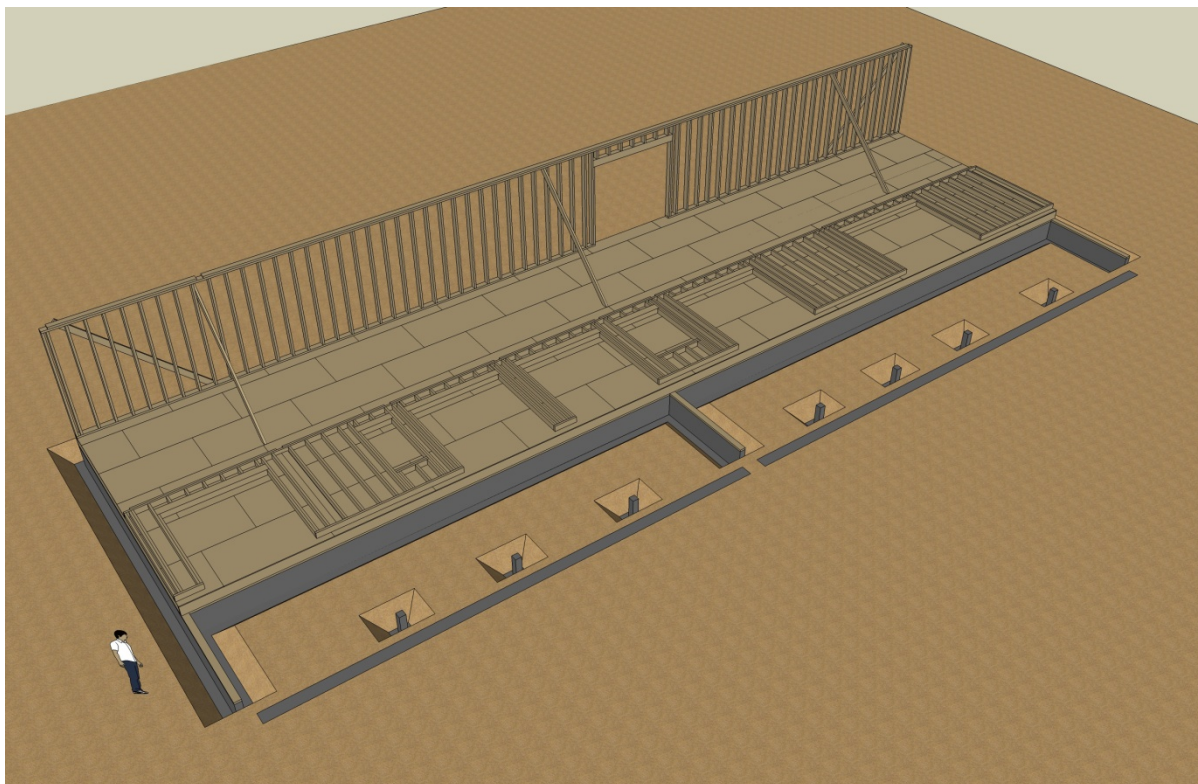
Montagem da segunda parede exterior sobre o pavimento.
